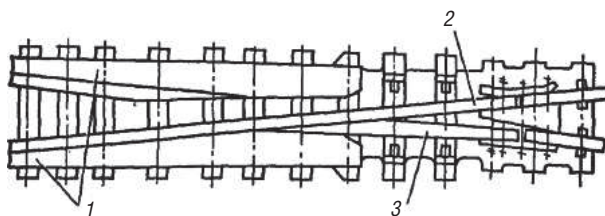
Крестовина с поворотным сердечником из остряковых рельсов:
